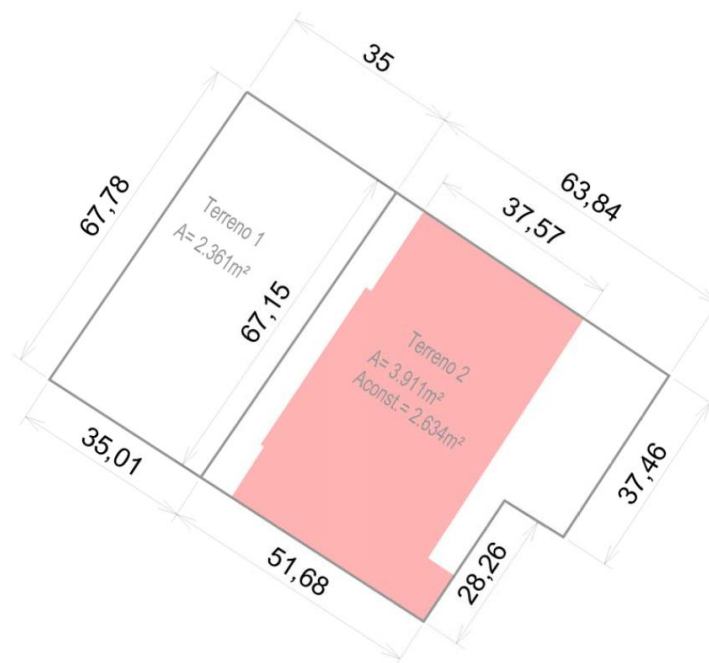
Planta dos terrenos desmembrados com indicação da construção existente em vermelho. Produzido pela autora.
